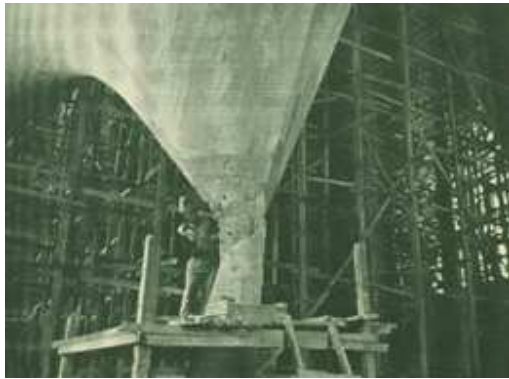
Columna colapsada en la Iglesia de la Medalla Milagrosa
